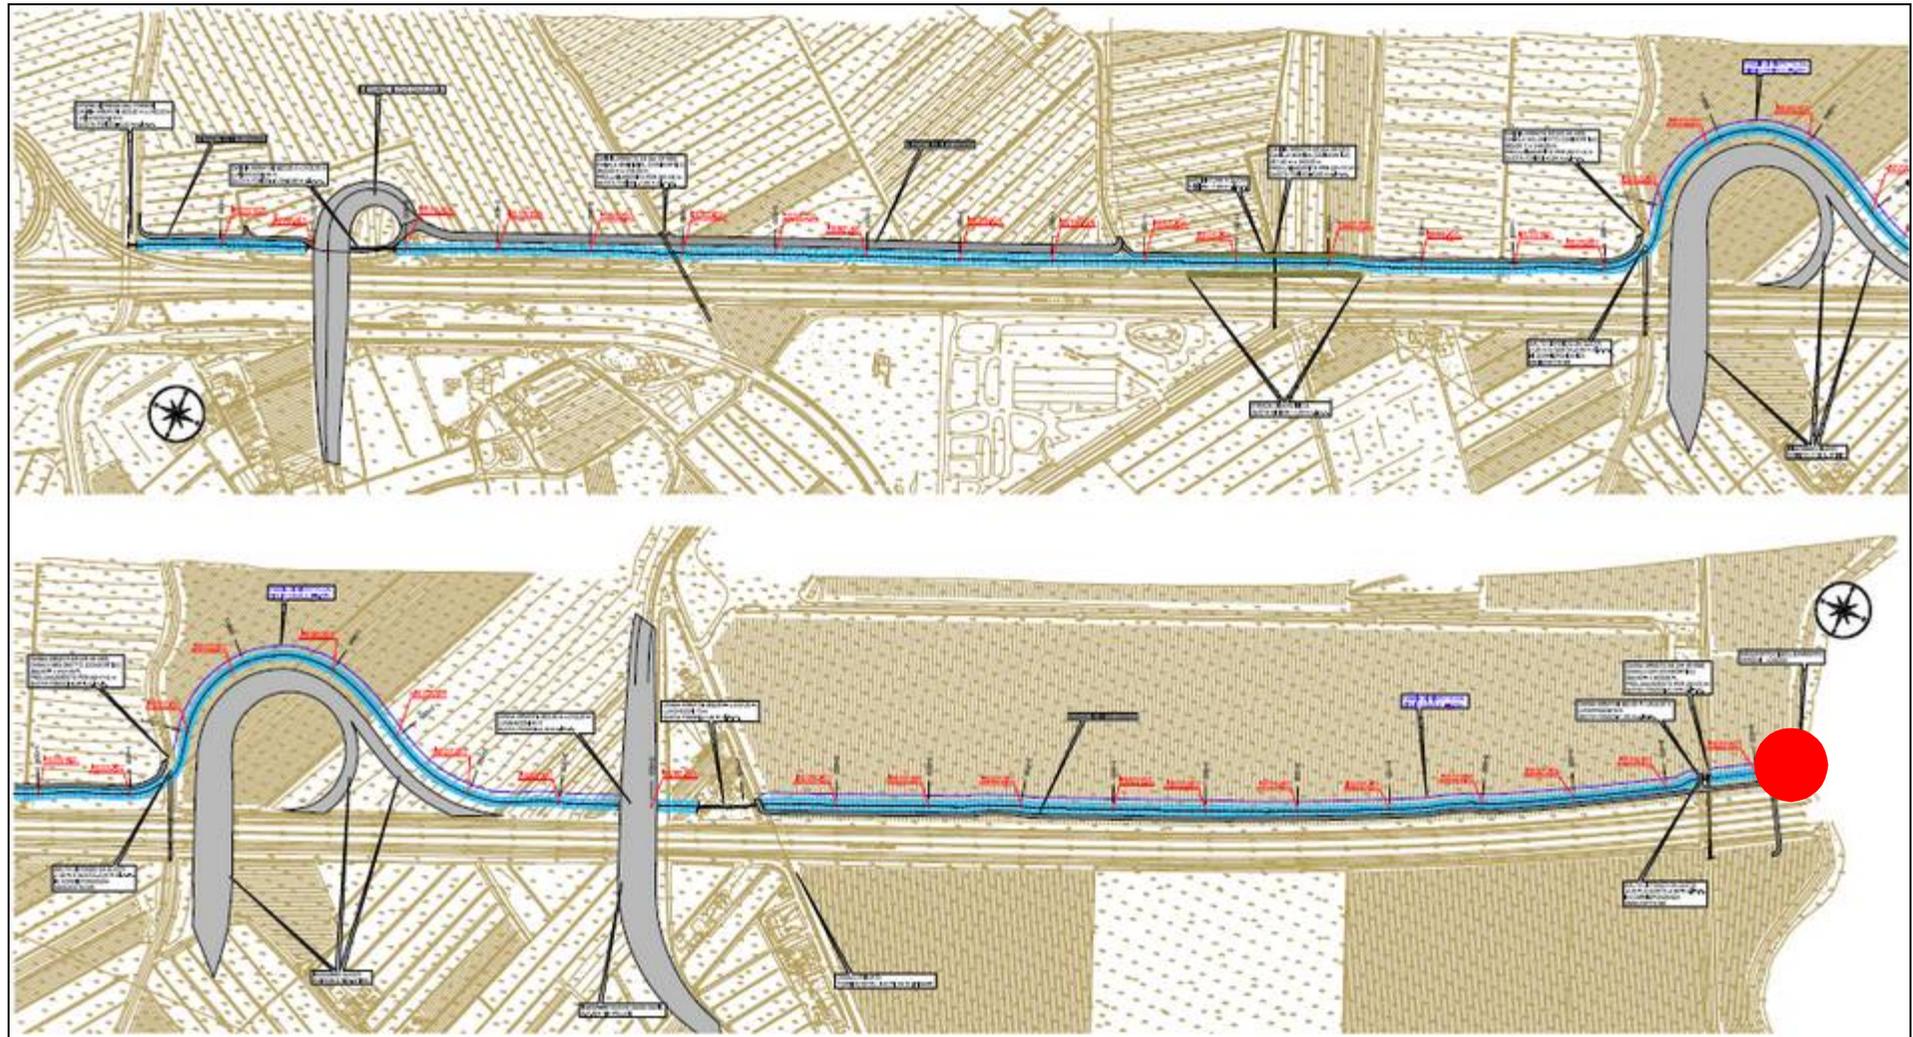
Estratto planimetrico del canale di gronda che collega il rio Fosson al fiume Loncon. Con un bollino rosso è indicata la possibile ubicazione dell'impianto idrovo progettato
